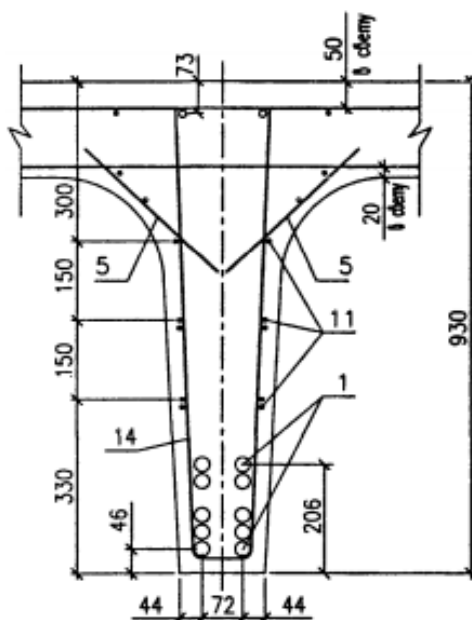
Армирование балки Б1500.130.93-Т28АШс
